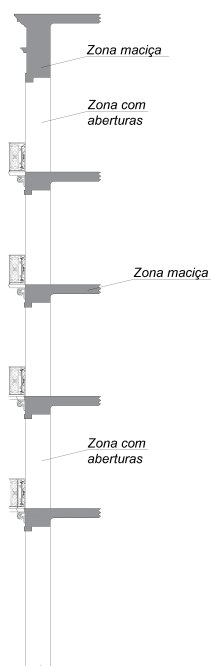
Ilustração da fachada tipo. Adaptado de [23]
